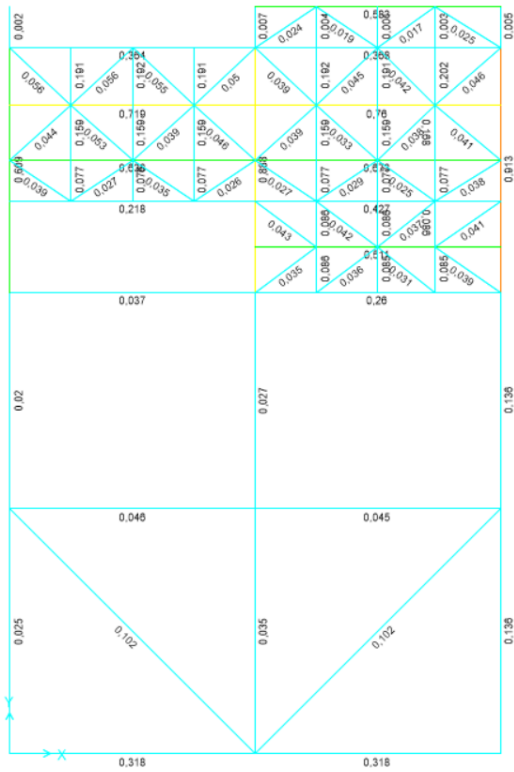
Factores de utilización vista en planta elevación 8.54 m.
